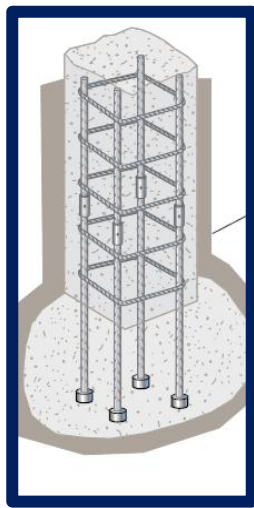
Conectores utilizados como cabezas de pilas y pies de columnas en fundaciones.
